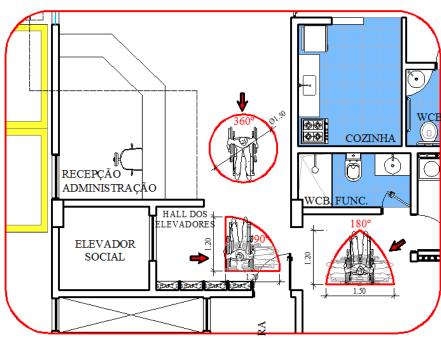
Áreas de manobra sem deslocamento no pavimento térreo (Detalhe 17)
